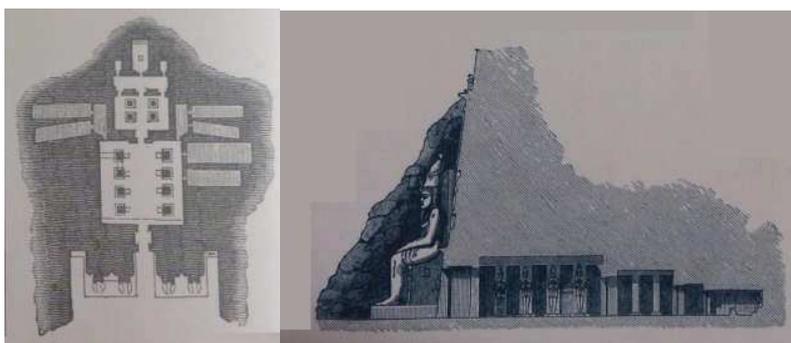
Planta e corte transversal do Templo de Abu Simbel. Fonte: COLE, 2011.
